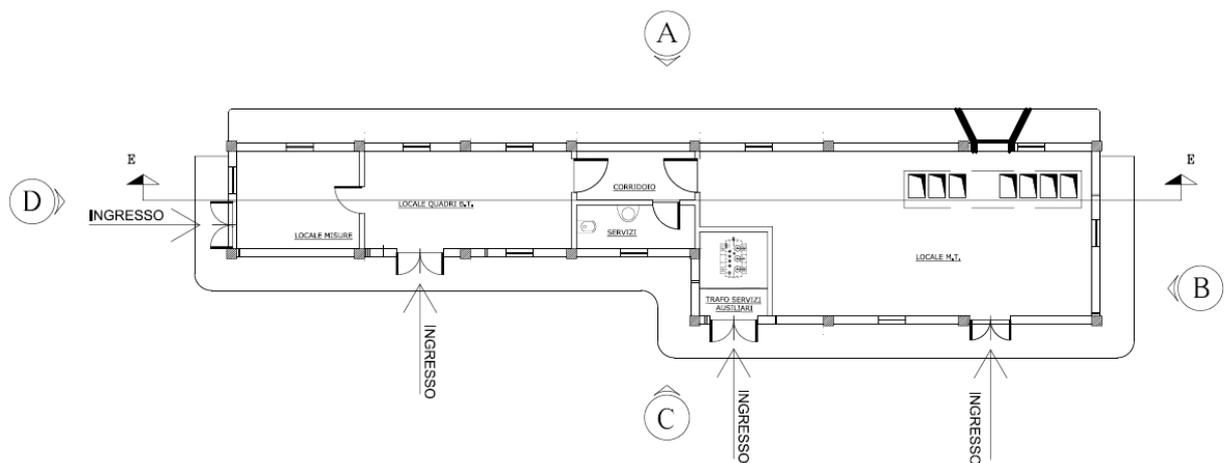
Locale utente a servizio della Stazione Trasformazione Falck
